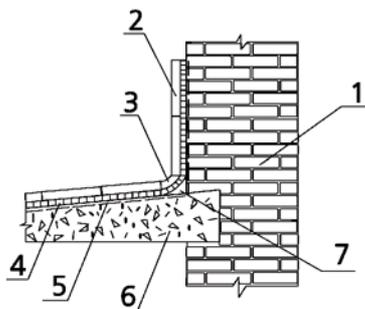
Устройство гидроизоляции террас и балконов.
